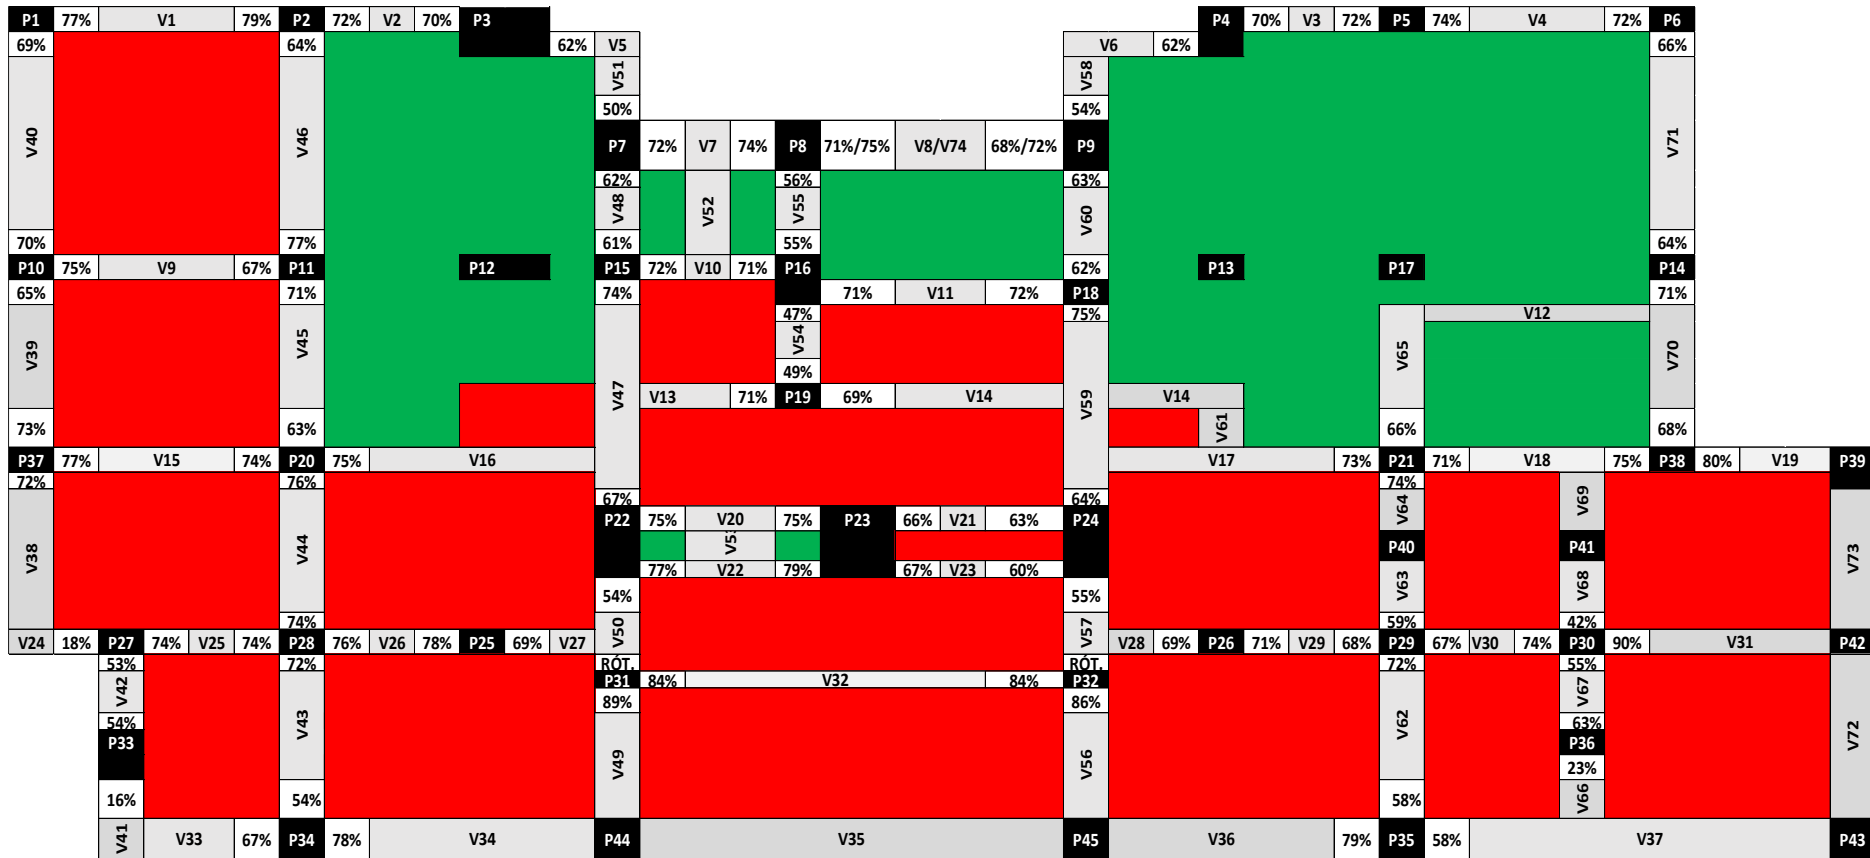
Fator de engastamento (β) das ligações do pavimento tipo para a iteração 1
